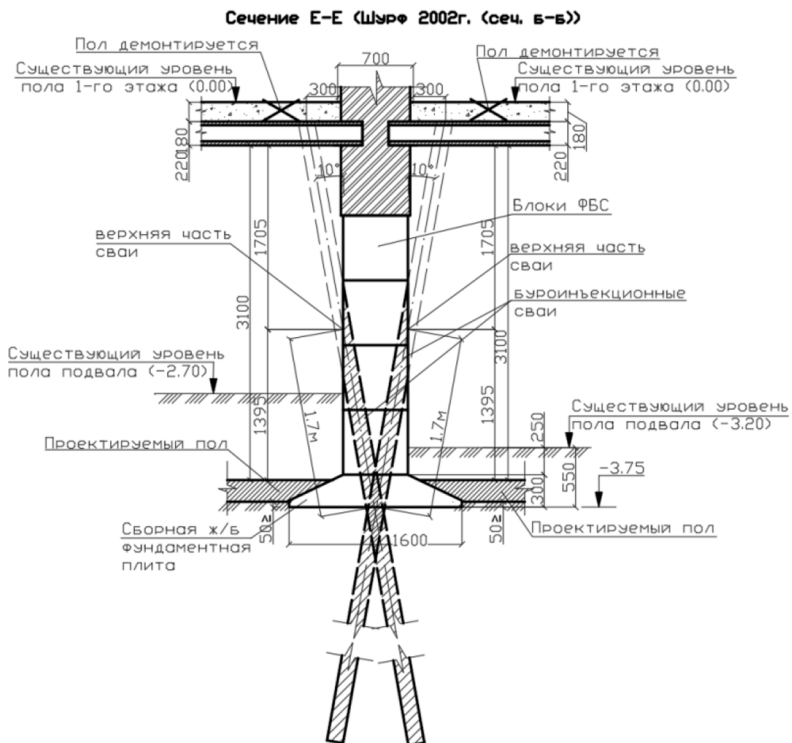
Поперечное сечение Е-Е усиленного основания фундамента
